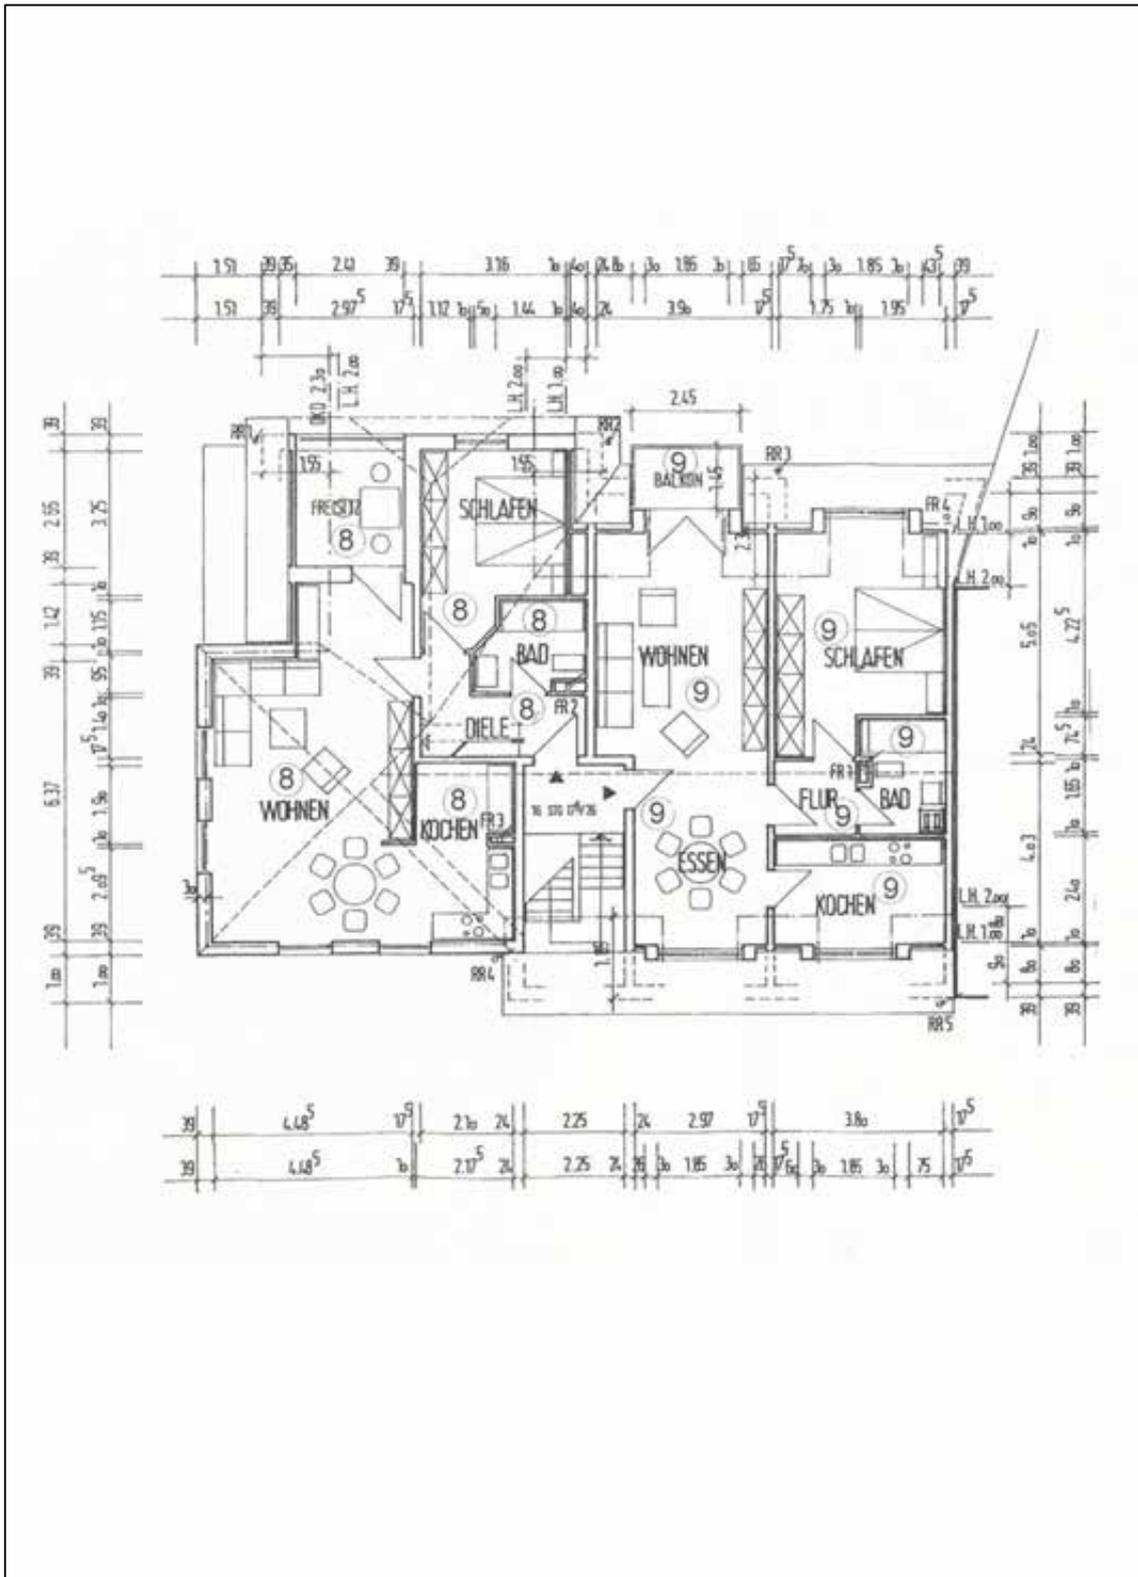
Grundriss vom Dachgeschoss
